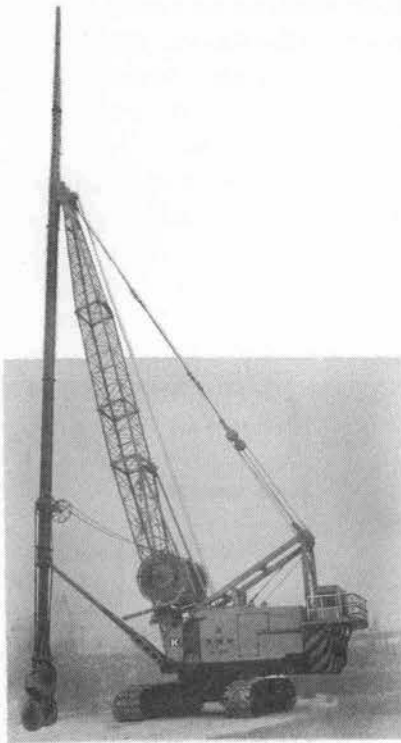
ソレタンシュ・ケリー 60 M 形掘削機
